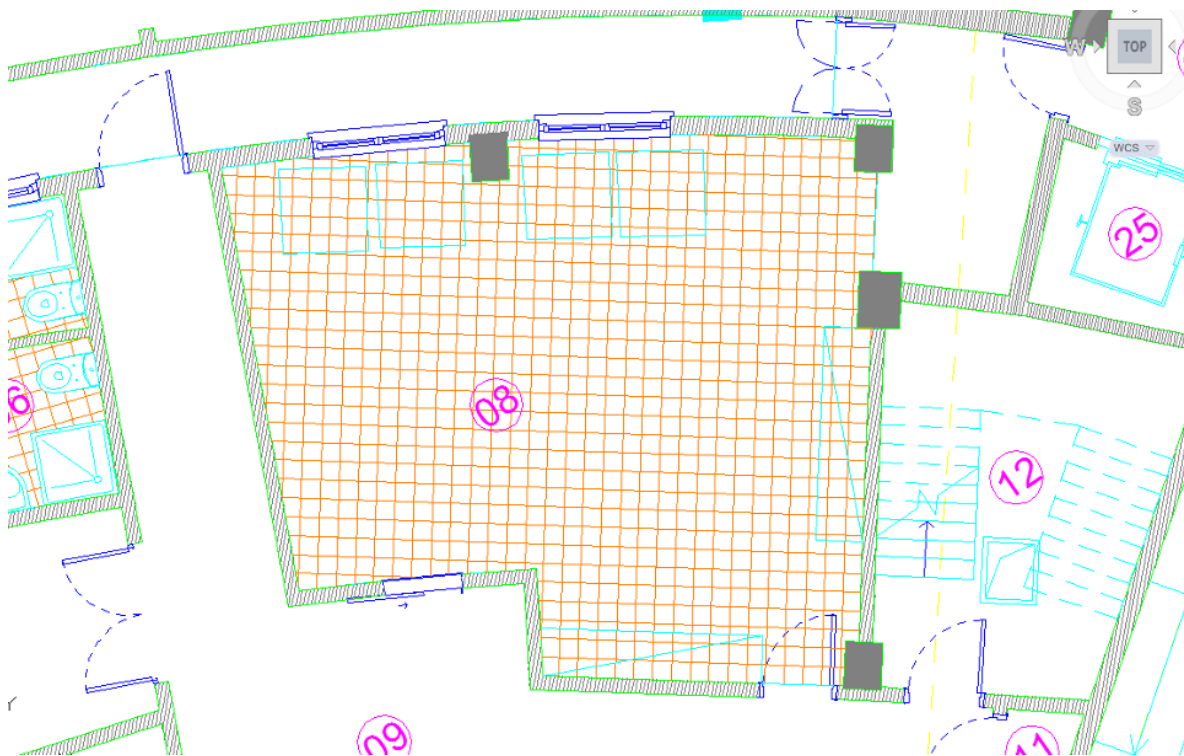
Planta piso -1 na zona da lavandaria [Atelier B2, 2016]
